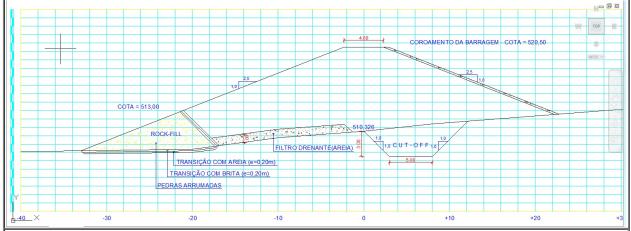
Perfil da barragem mostrando o Rock Fill (Projeto apresentado pela Prefeitura de Picuí).
